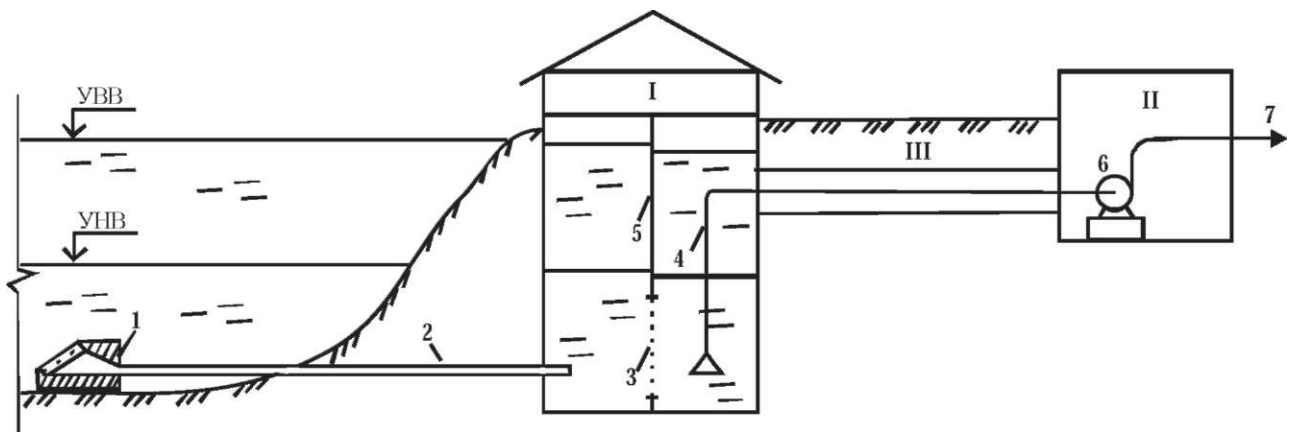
Руслівий водозабір роздільного типу: I - береговий колодязь; II - насосна станція 1-го підйому; III - канал для всмоктуючого трубопроводу; 1 - оголовок; 2 - самопливний трубопровід; 3 - сітка; 4 - всмоктуючий трубопровід; 5 - перегородка; 6 - насоси; 7 - напірний трубопровід
